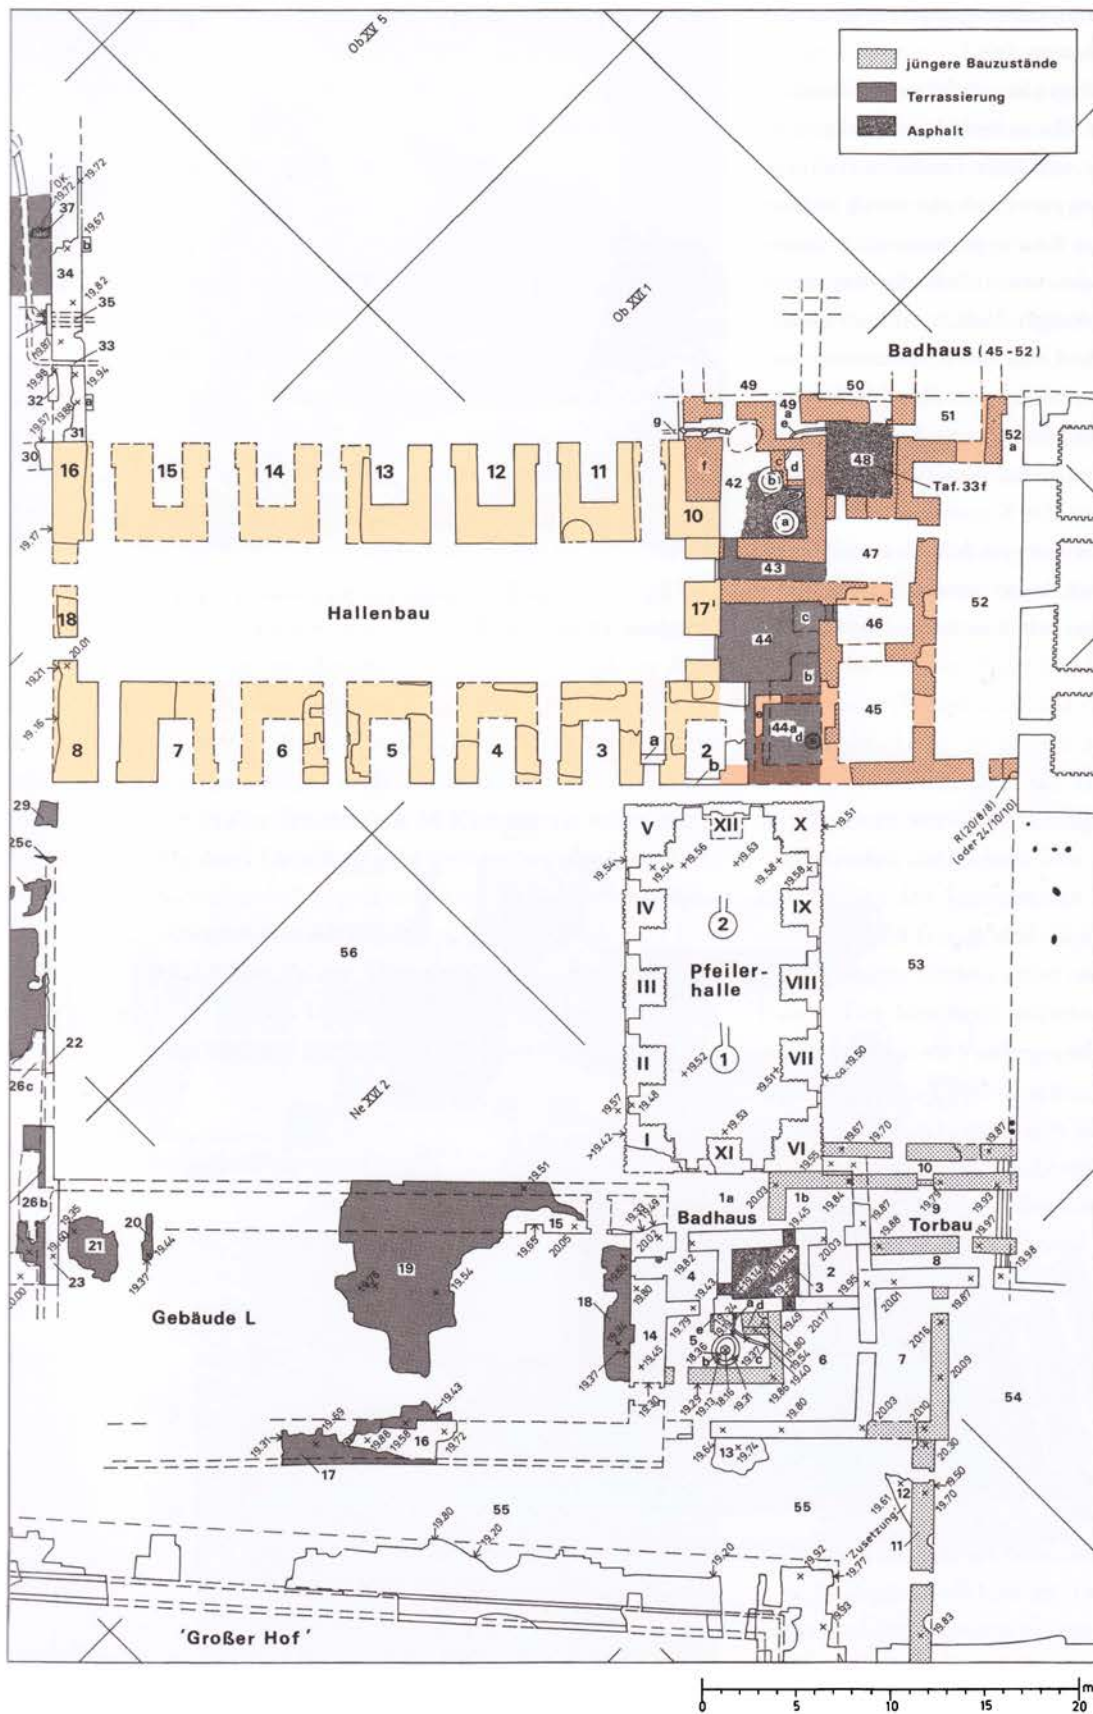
Grundrissplan des ‚Hallenbaus‘. An seiner südöstlichen Schmalseite wurde der Bau, um das ‚Bad‘ anzulegen, um eine Pfeilerreihe verkürzt, d. h. diese abgerissen
